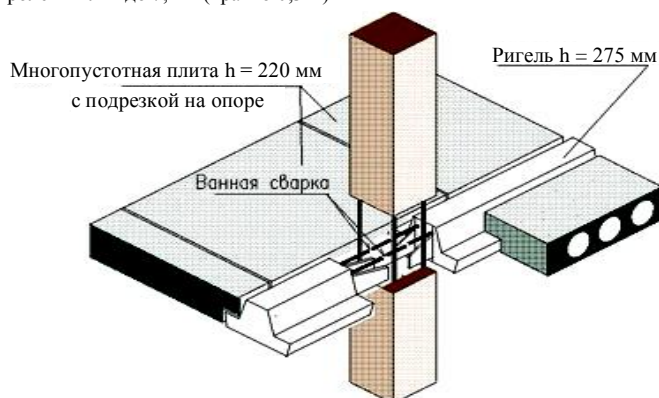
Конструктивные решения каркасного здания с плоскими перекрытиями
